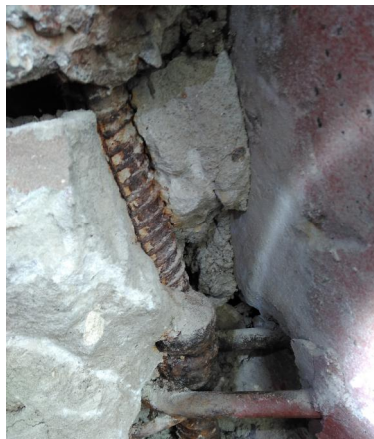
U-подібні арматурні елементи з'єднання стінових панелей з колонами відгинають арматуру стику за рахунок вертикальних переміщень панелей
